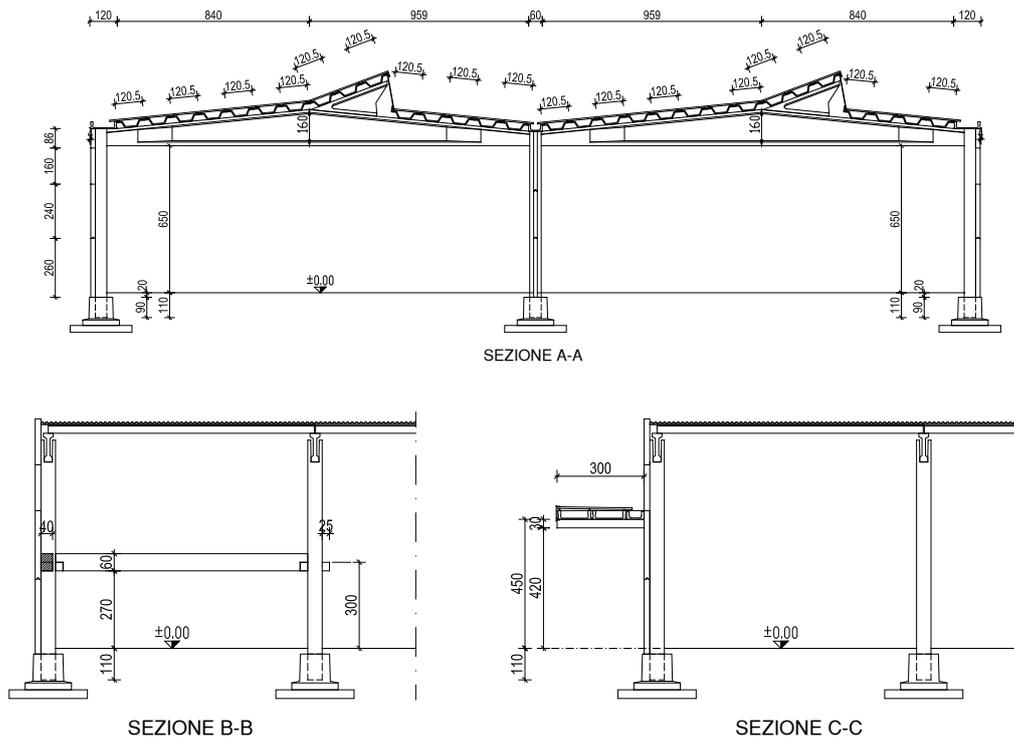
Sezioni pianta edificio prefabbricato monopiano (anno 1996)
